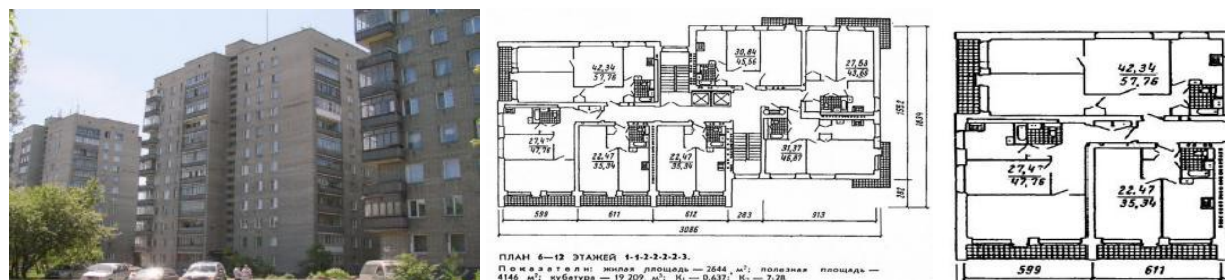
Пример кирпичного дома серии Щ-5416 в Санкт-Петербурге, 1968г., арх. В. Ф. Белов. Общий вид, план типового этажа, план жилых секций
